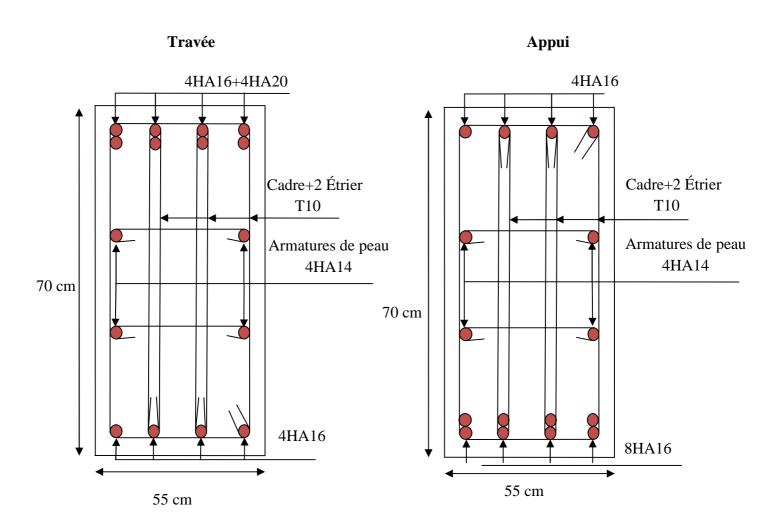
Schéma de ferraillage de la nervure Sens y-y
